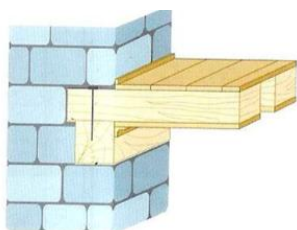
Apoio pavimento-viga através de frechal existente na parede [1]
